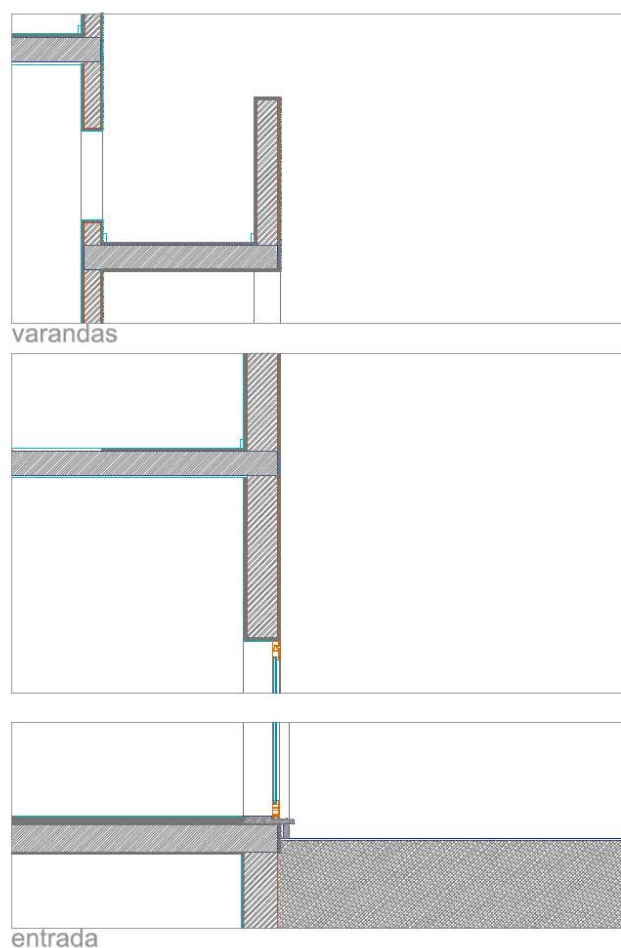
Fachada existente. Corte construtivo (escala 1/50).
